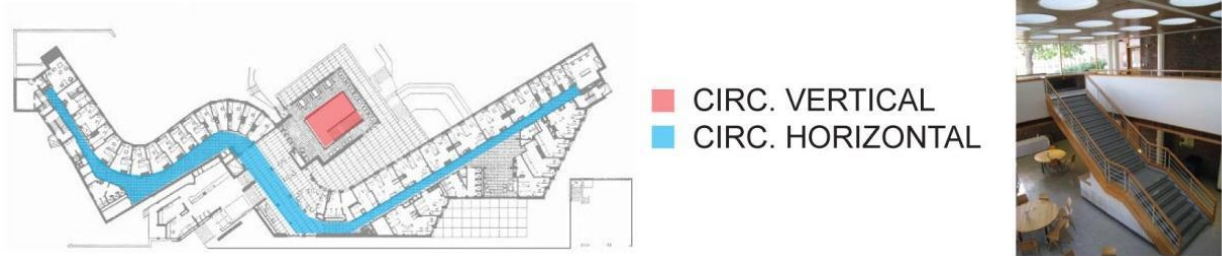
Fuente: <http://www.archdaily.com/61752/ad-classics-mit-baker-house-dormitory-alvar-aalto/plan-28/>
